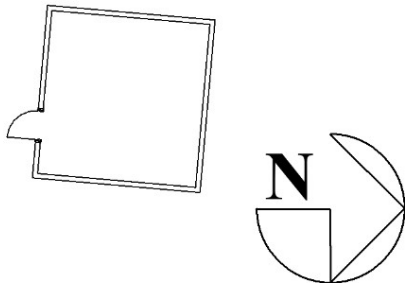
Planta Edificio 3, Zona 2, sin escala.
